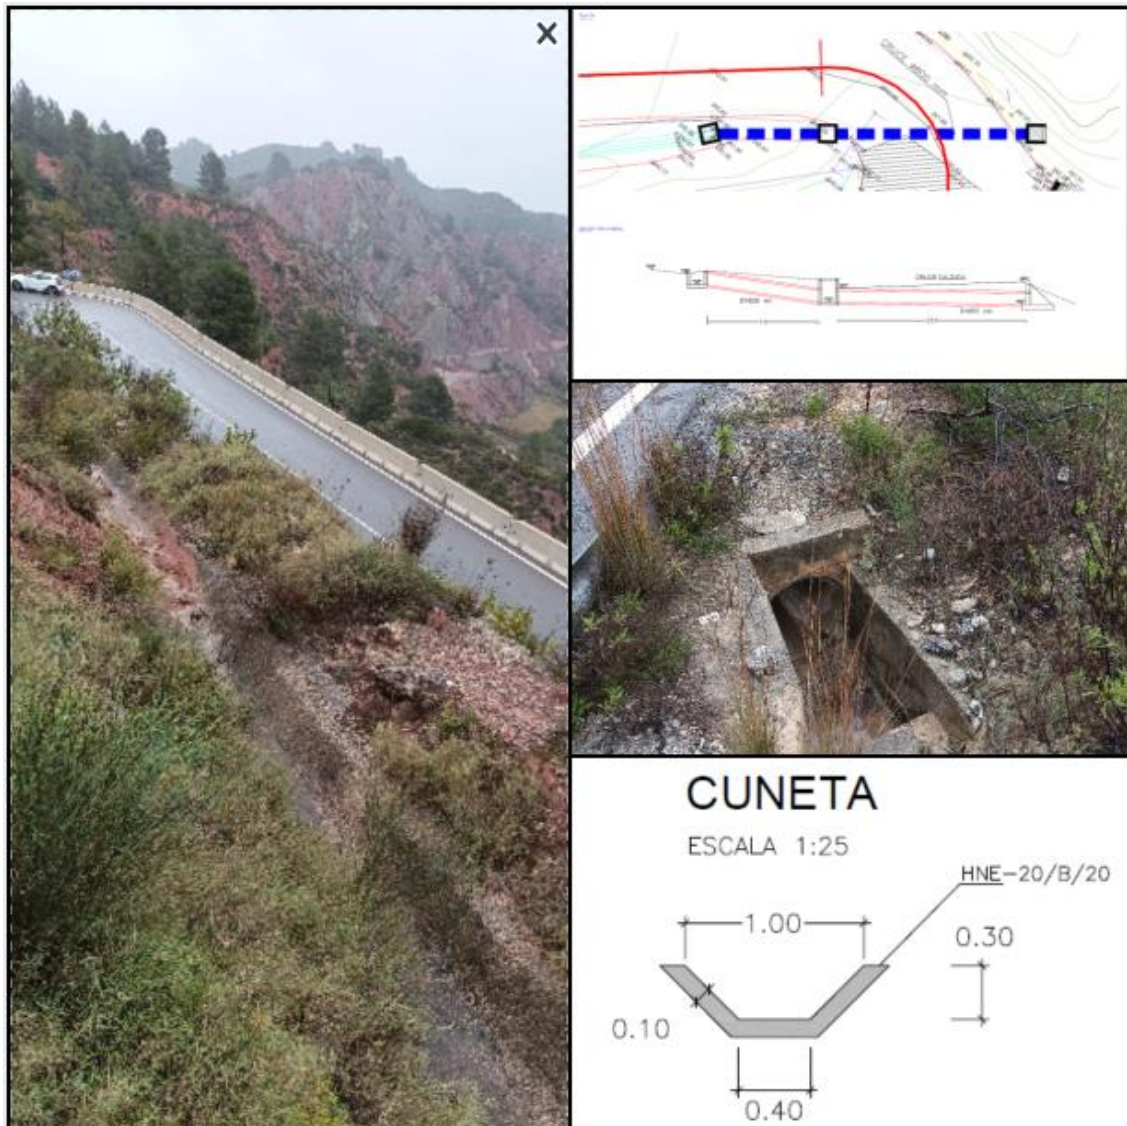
Drenaje en planta y detalles. Fuente: Prodein, S.L. y Propia.
